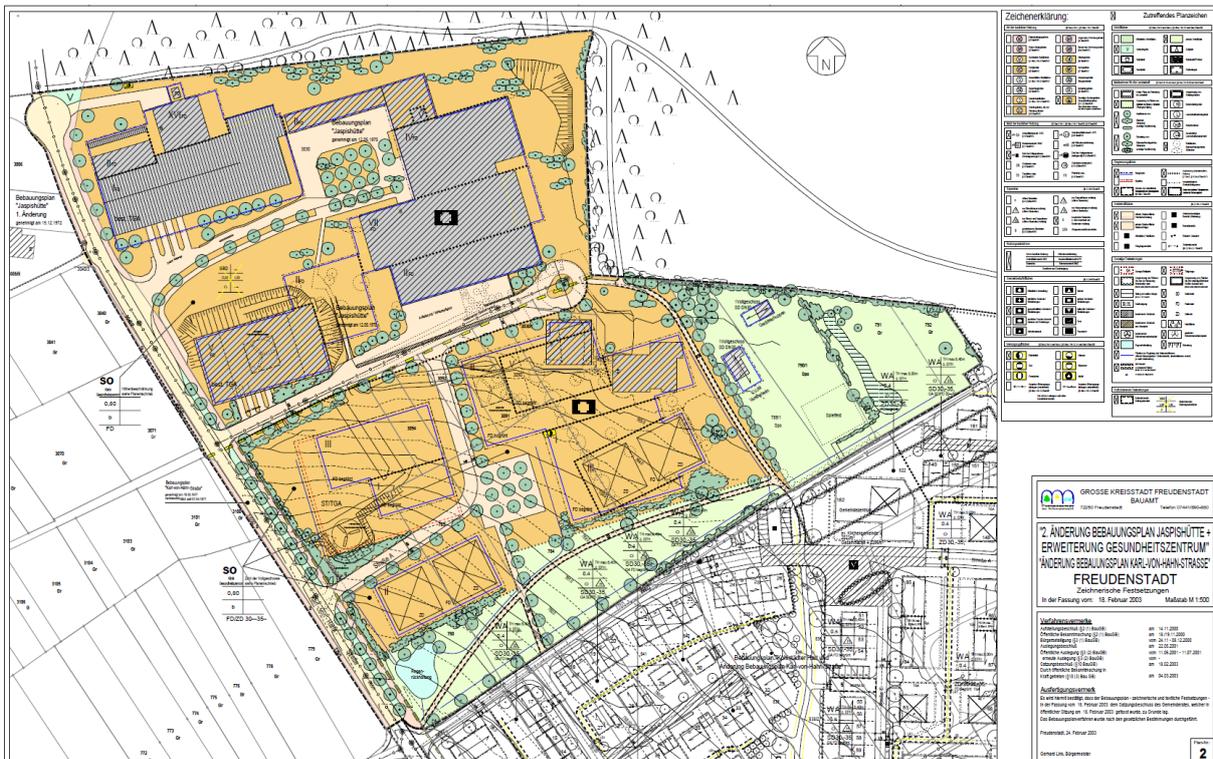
Bebauungsplan „2. Änderung Jaspishütte und Erweiterung Gesundheitszentrum“
